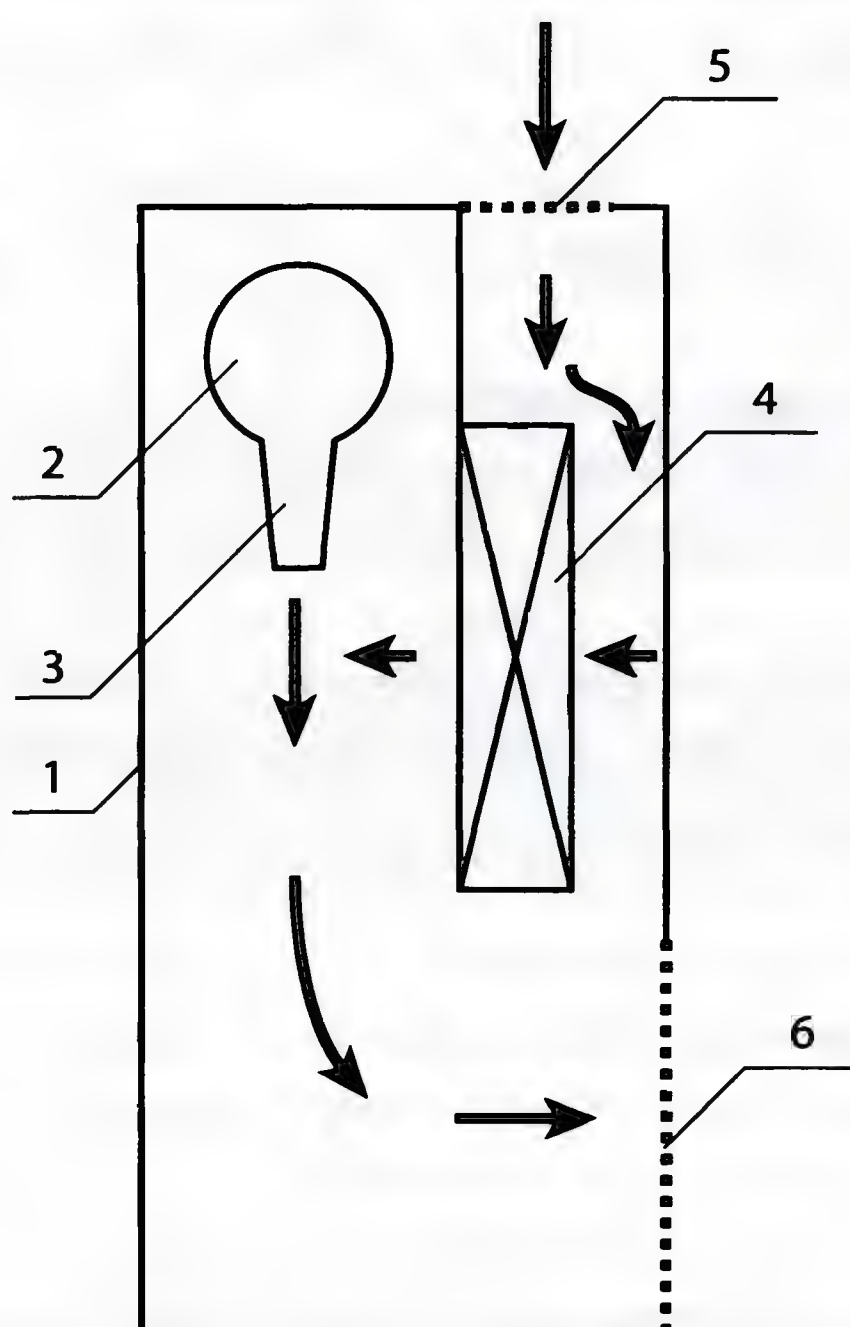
Схема эжекционного доводчика для вытесняющей вентиляции:
